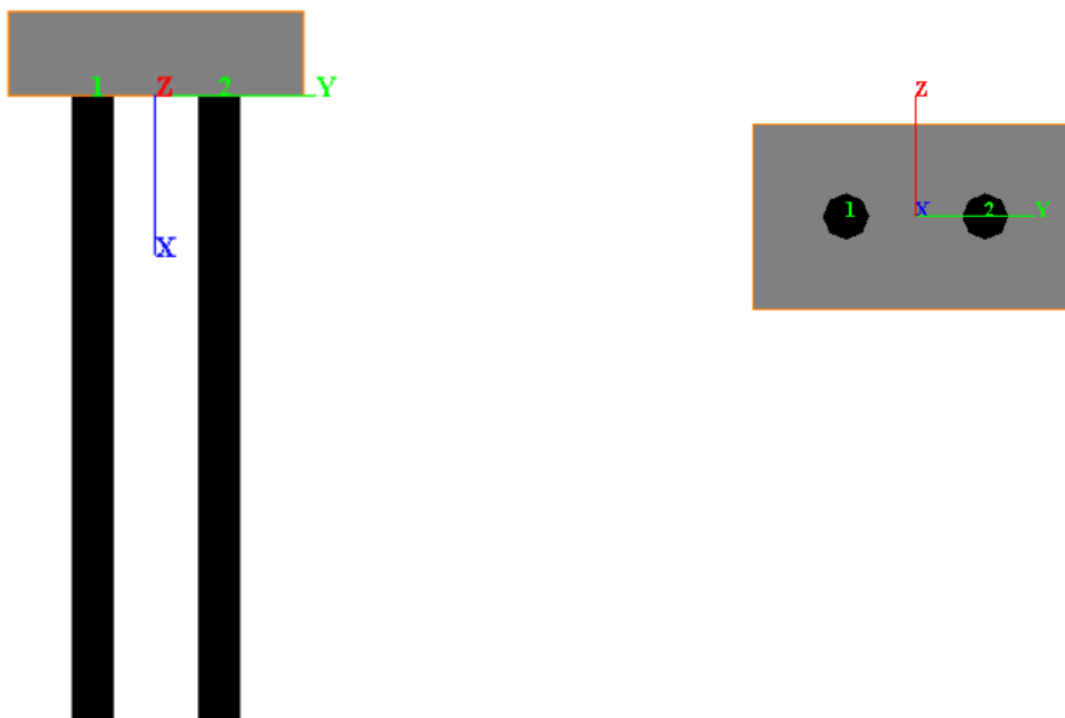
Vista laterale e in pianta del modello Group per le fondazioni
